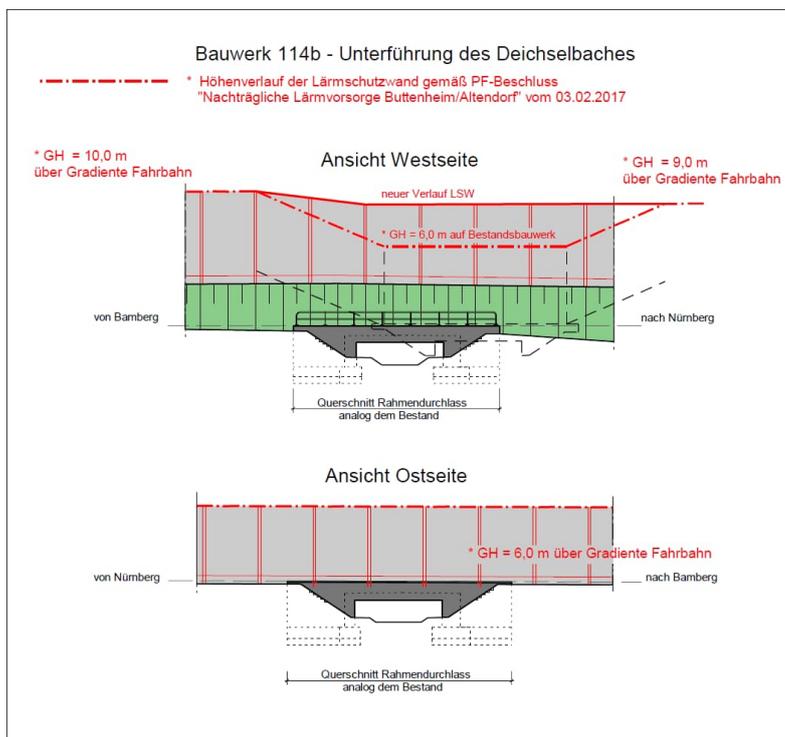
Auszug aus Lageplan Unterlage 5 Blatt 5, Ansicht
